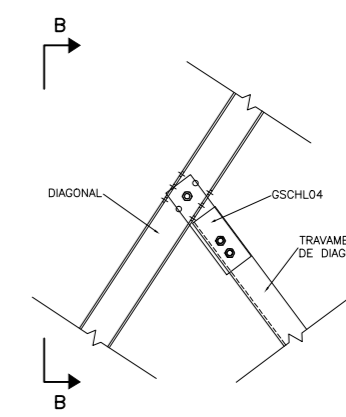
DETAILHE DE FIXAÇÃO DE CHAPAS DE LIGAÇÃO
